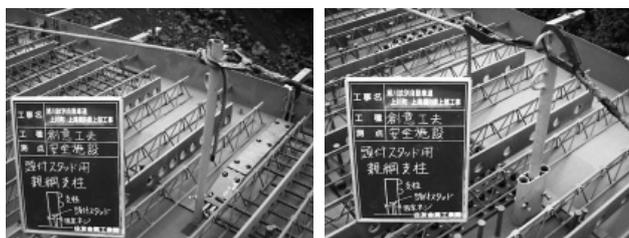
1本タイプ親綱支柱 写真-3 2本タイプ親綱支柱
